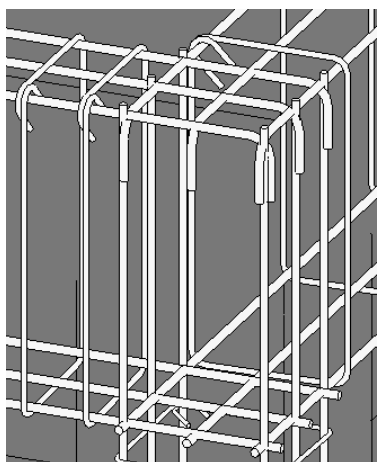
Nós do pórtico entre as vigas V2-3 e V2-4 e o pilar P11
